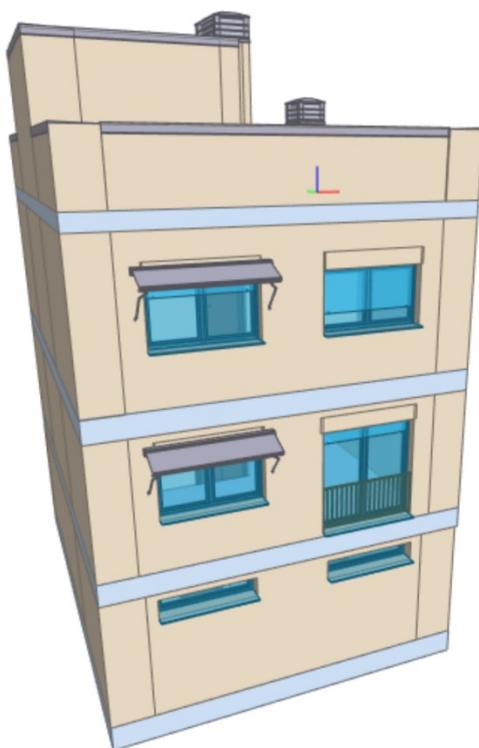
Stato avanzamento lavori Day1 prospetto Sud.
